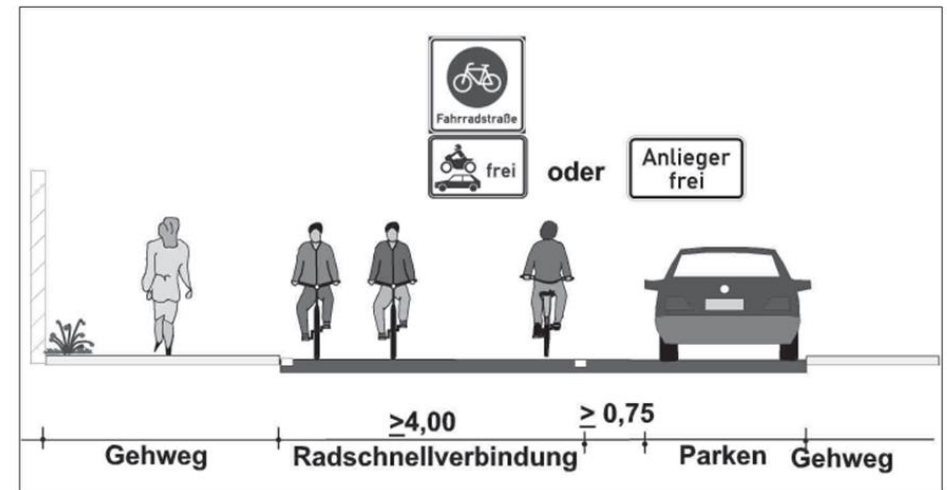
Führung der Radschnellverbindung als Fahrradstraße in Erschließungsstraßen
